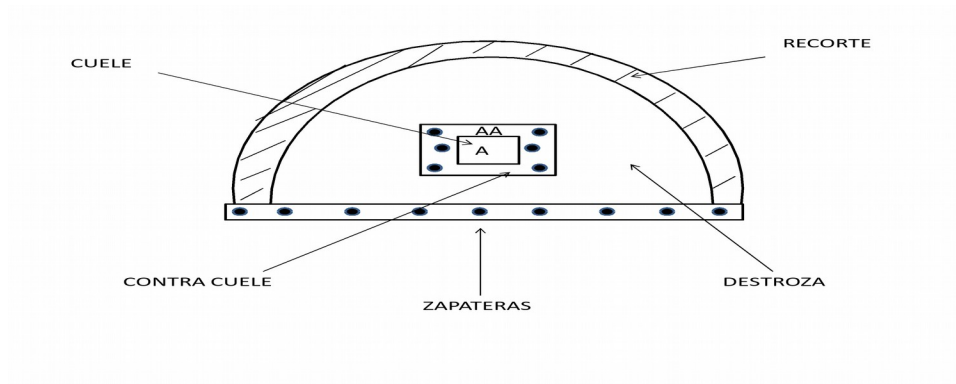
ZONAS DE VOLADURA DE UN TUNEL
